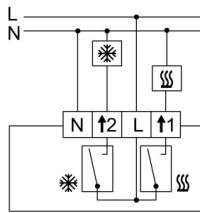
Zapojení termostatu typu 1099 UHK pro dvojtříčkové systémy
